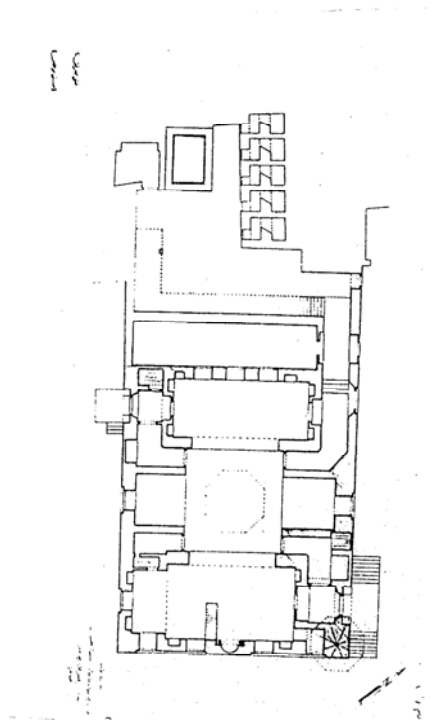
مسقط أفقي لمدرسة قايتباي بجزيرة الروضة
